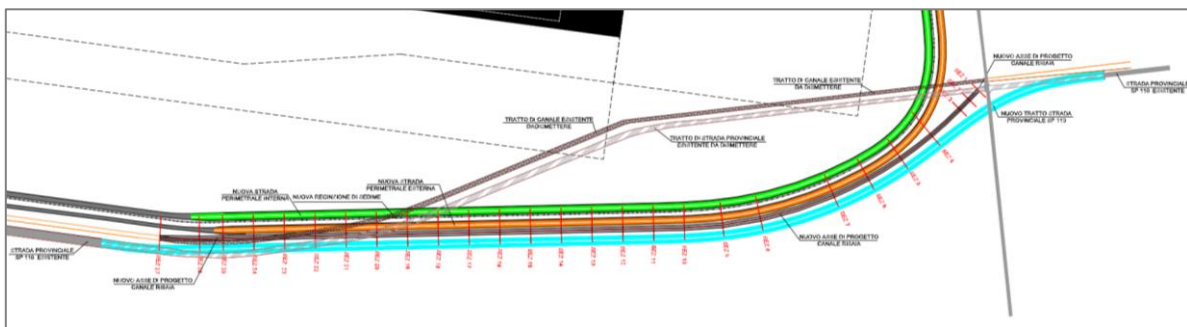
Planimetria Canale Risata Progetto esecutivo di prolungamento della pista di volo THR 28
